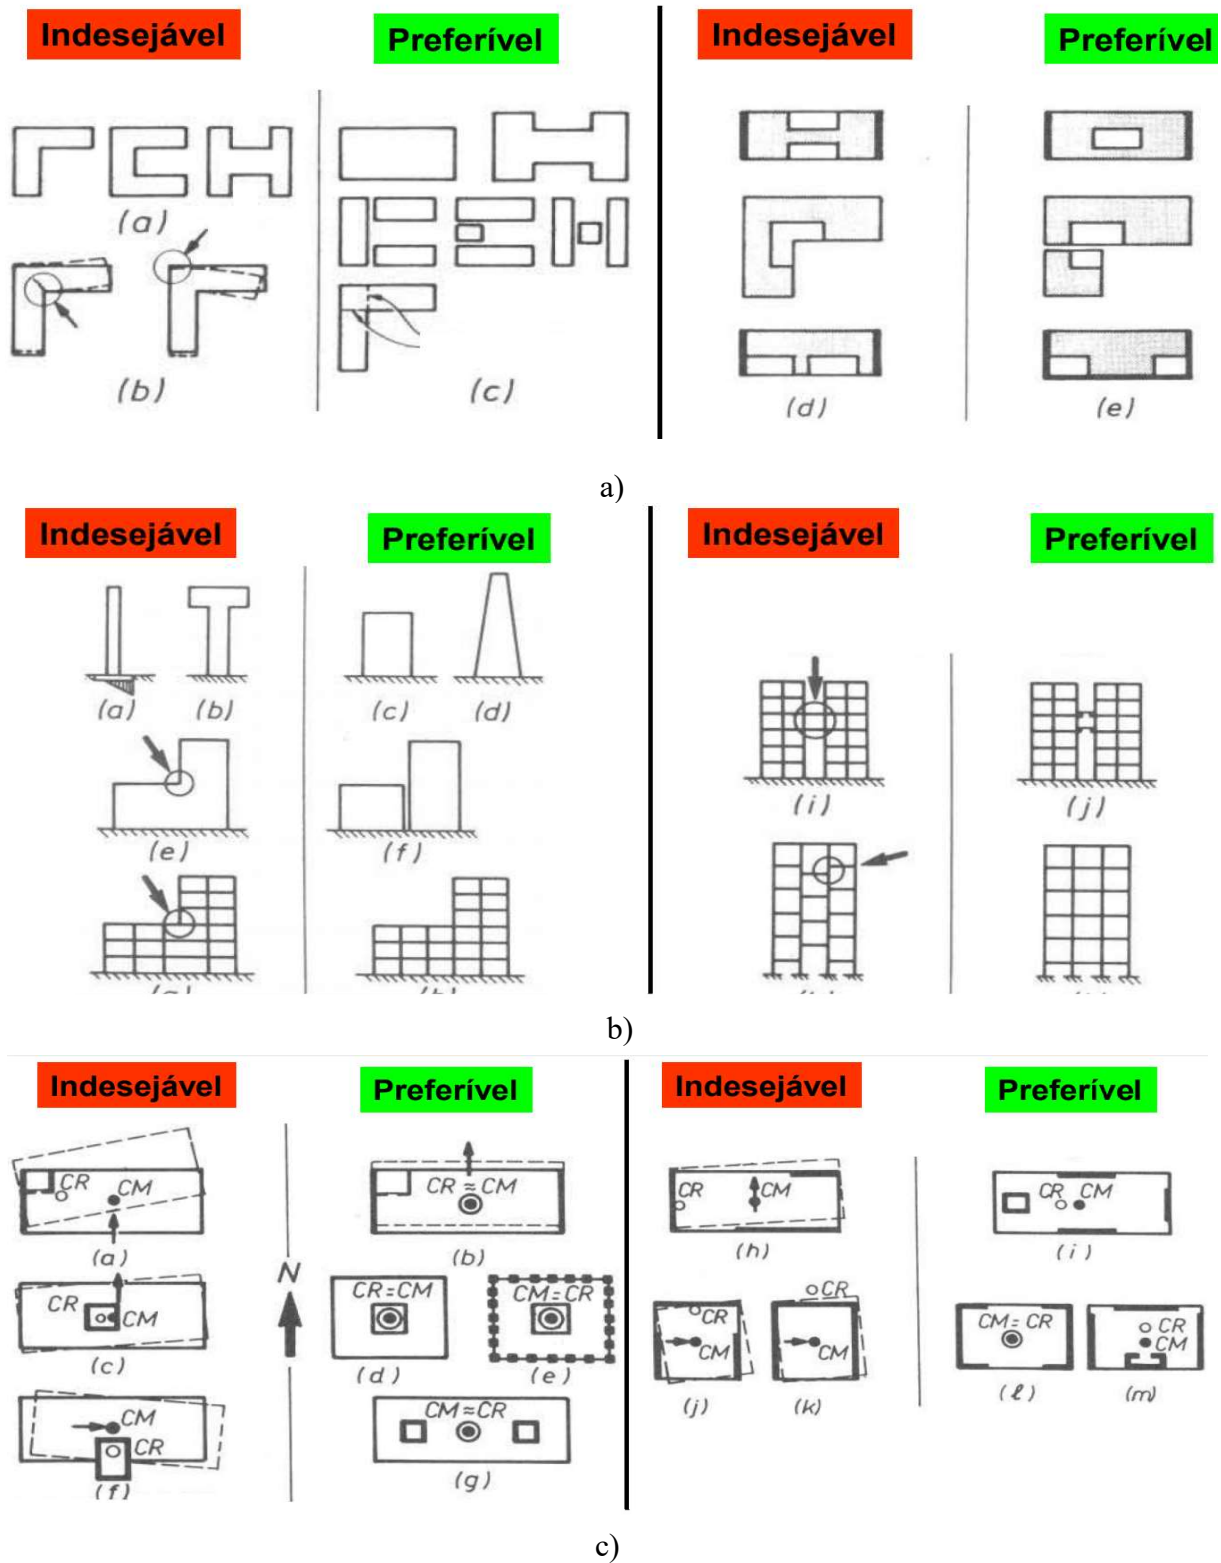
Configurações geométricas a considerar no projeto sísmico (adaptado de Paulay e Priestley (1992)): (a) em planta, (b) em elevação e (c) distribuição de massa e rigidez
